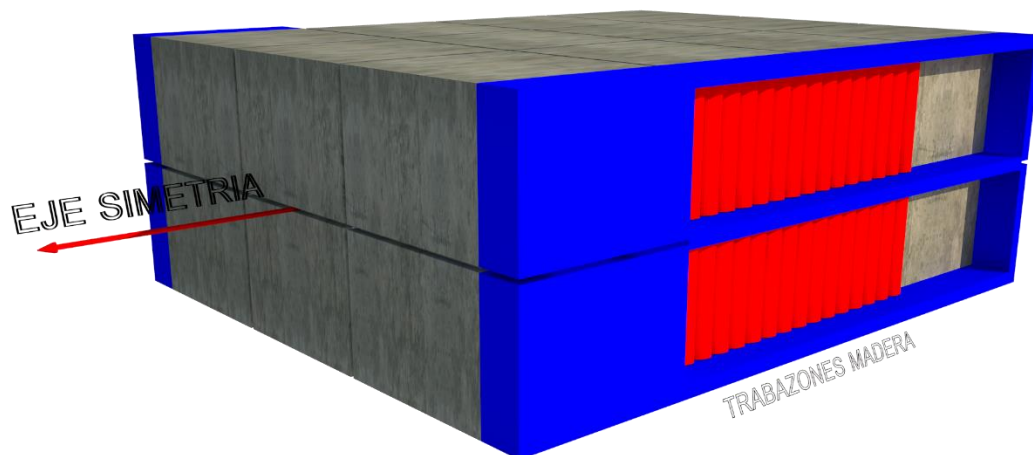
Trabazones en marcos de planta baja y de planta alta.
